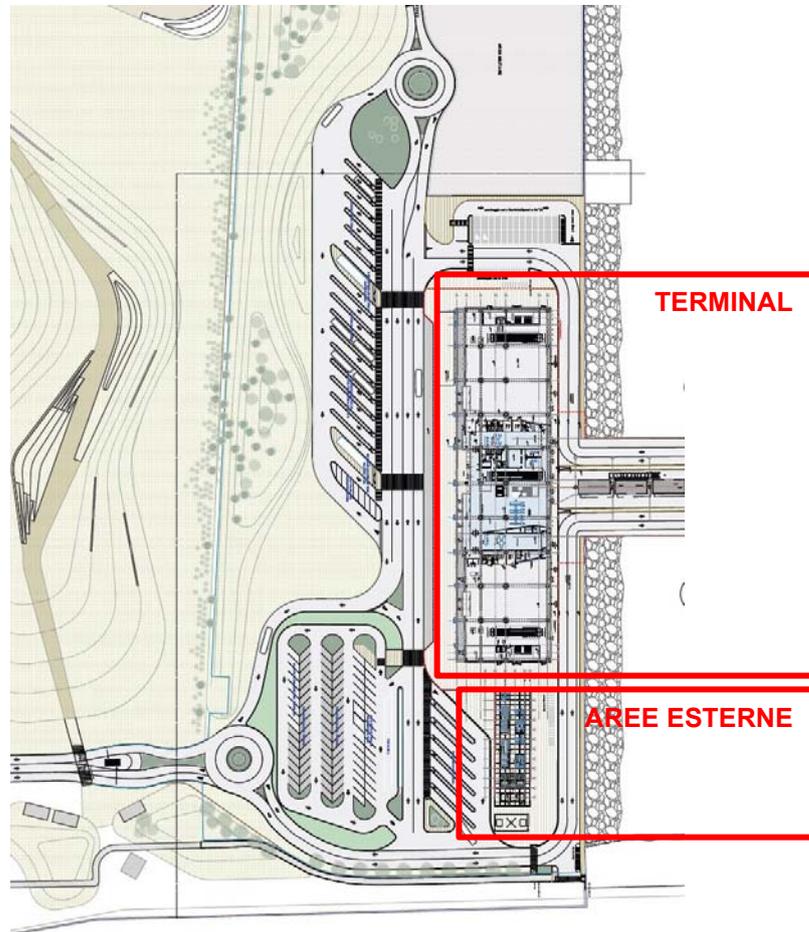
planimetria generale, Terminal ed aree esterne (lato Ovest)
